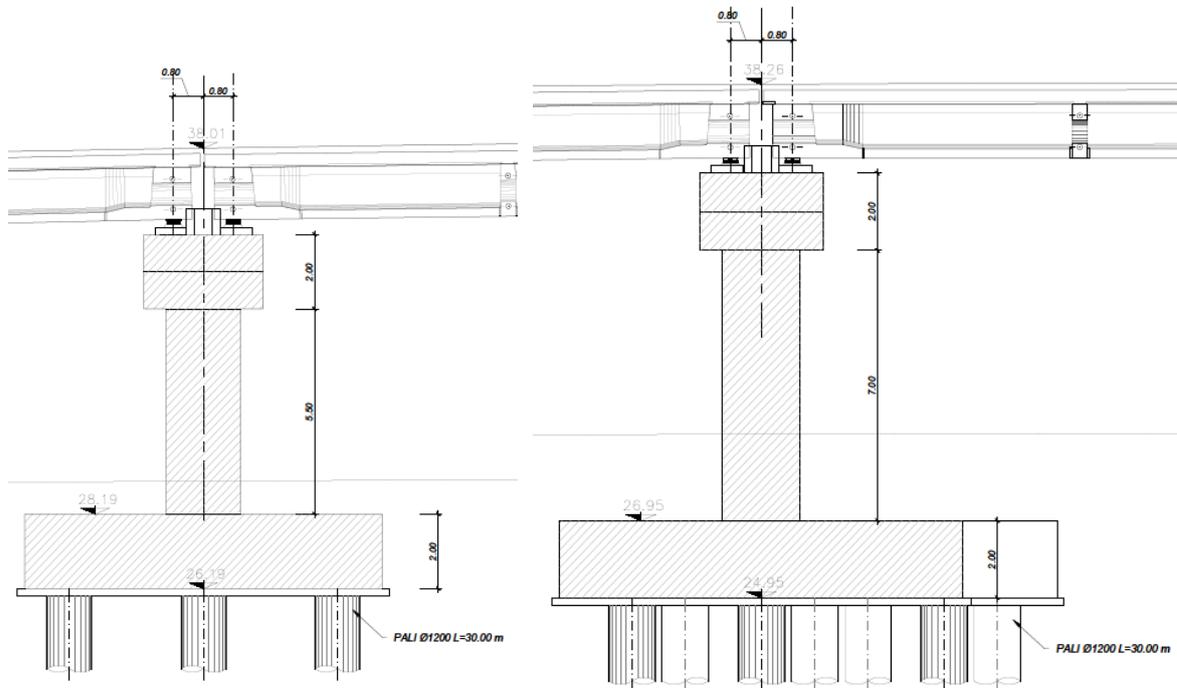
Sezione in direzione longitudinale pile 1-4 ; b) Sezione in direzione longitudinale pile 2-3
